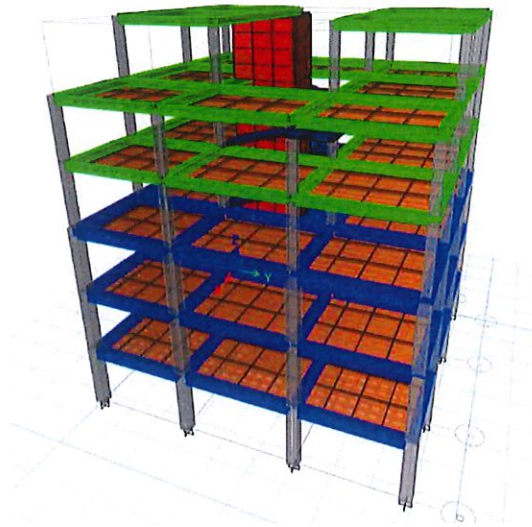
Vista en 3D de la estructura de 6 pisos con cubierta accesible de la estructura de hormigón en ETABS.
